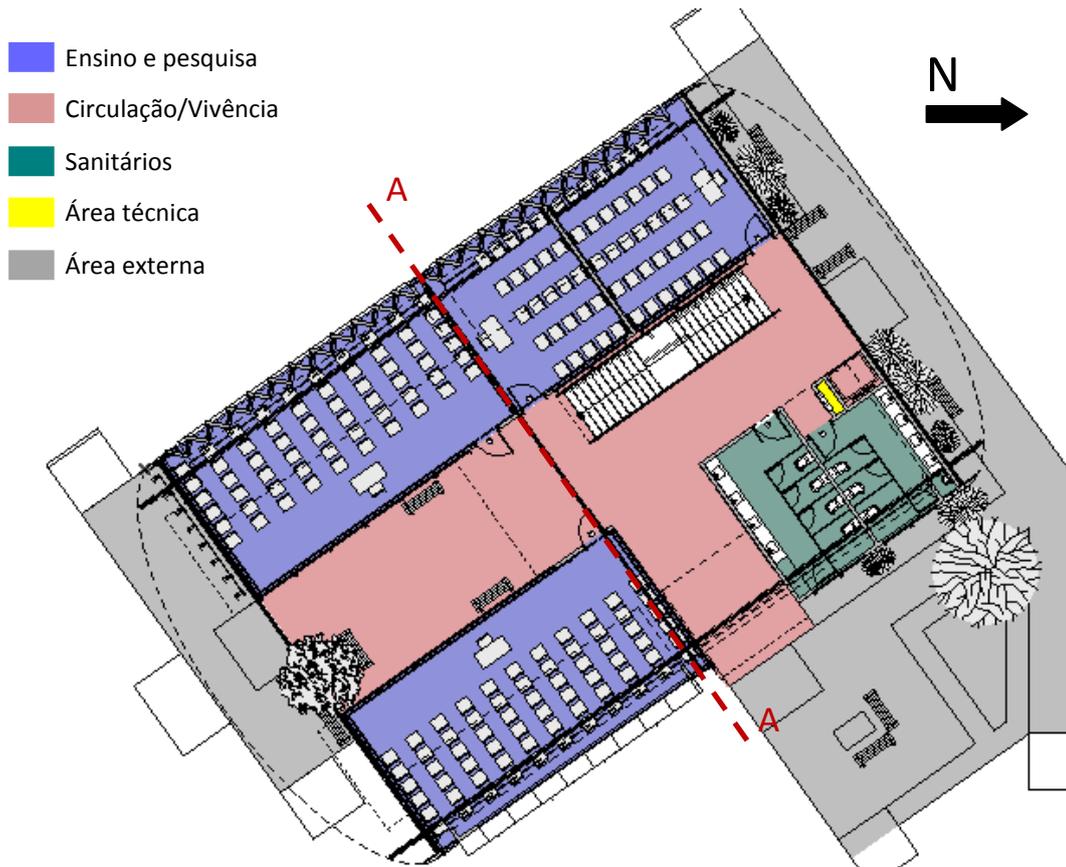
Planta baixa esquemática do 1º pavimento, térreo, do NEM-CAR e sua setorização.
